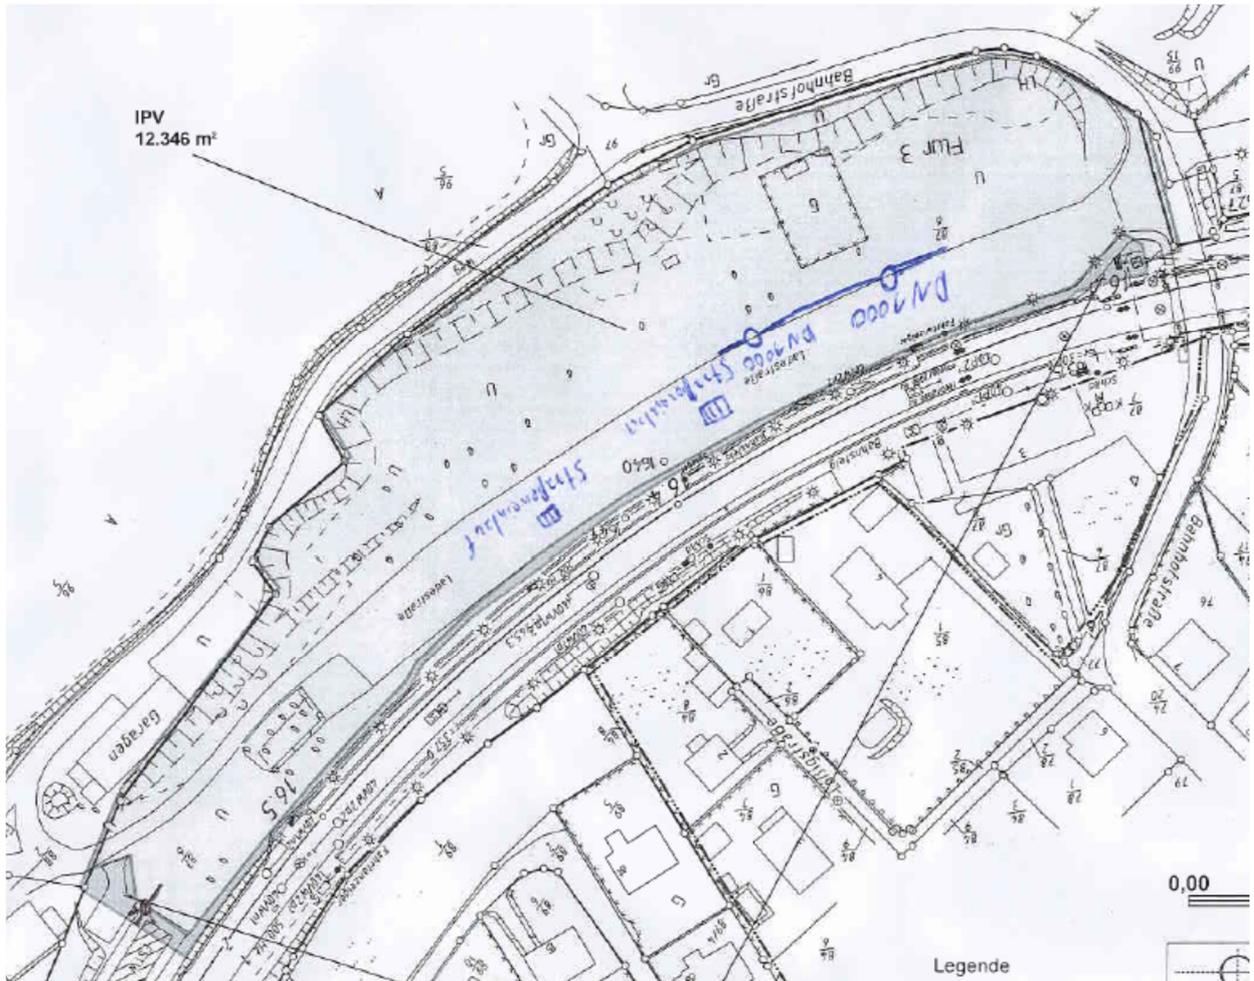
Plan aus dem Jahr 2013 vom Gelände mit Darstellung der Ladestraße
